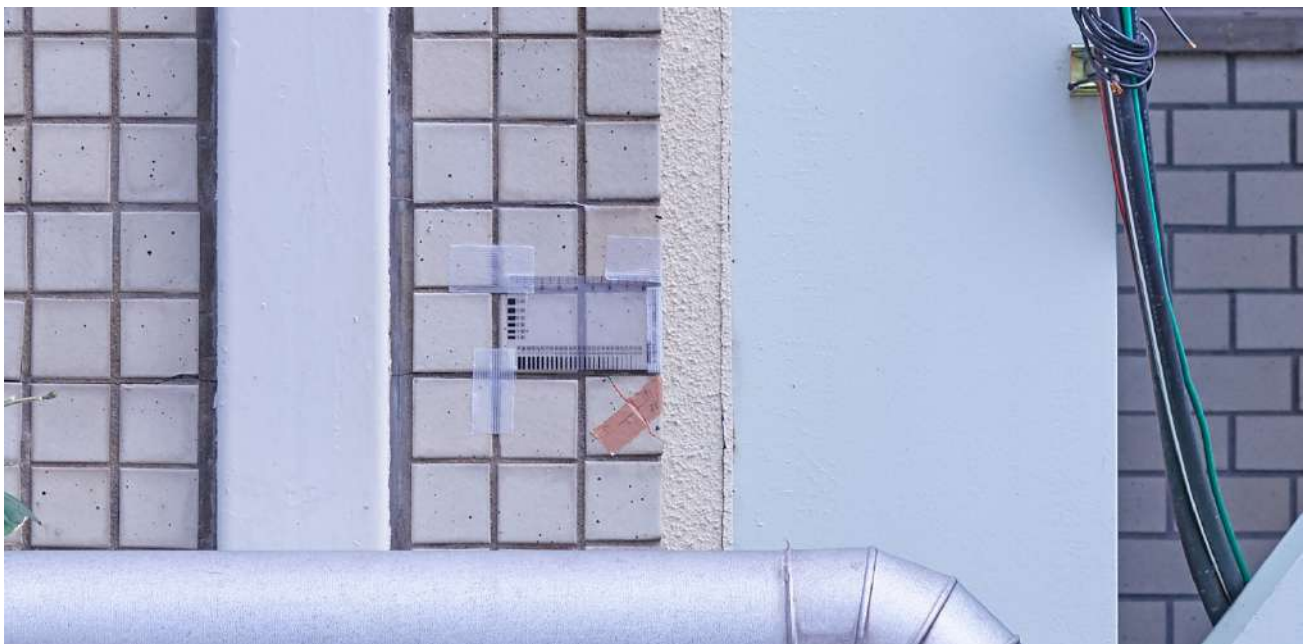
ドローンによるひび割れの撮影調査 (1階の柱, X, 撮影距離5m)
